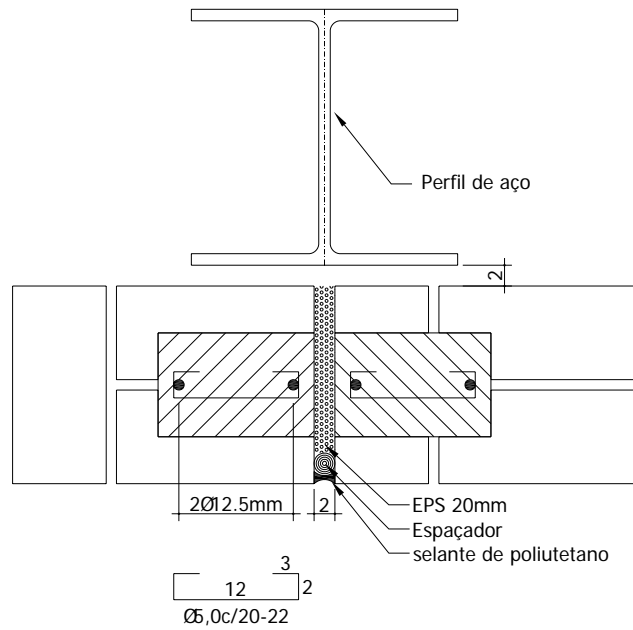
Detalhe de uma junta posicionada no eixo de um pilar da fachada.
